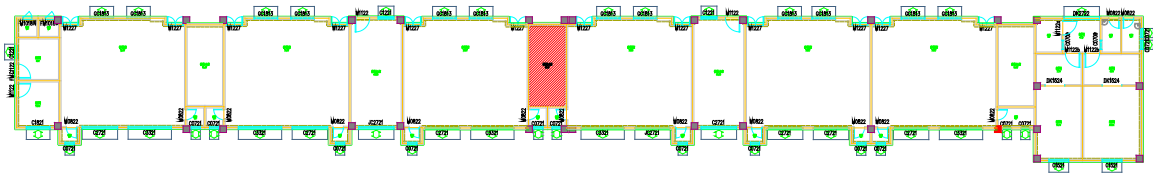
受建筑内设备噪声影响的典型房间楼层平面图
